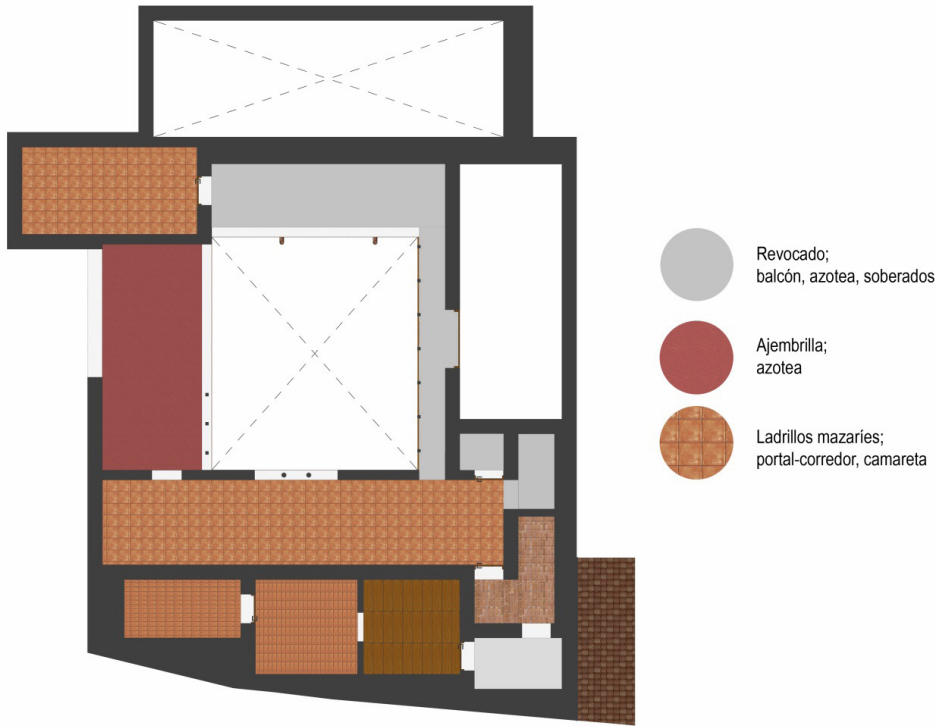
Detalle de los suelos de la planta alta en la casa en la zona de las Cruces (actual Ximénez de Encisos) [Fuente: La autora].
